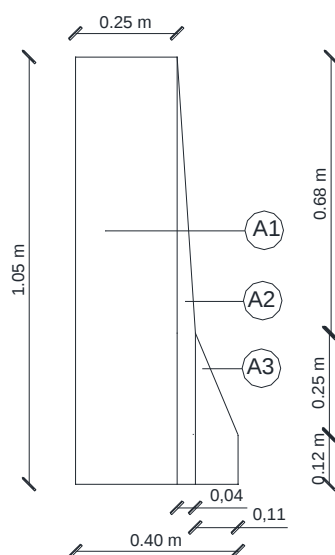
Dimensiones de la baranda de concreto armado
